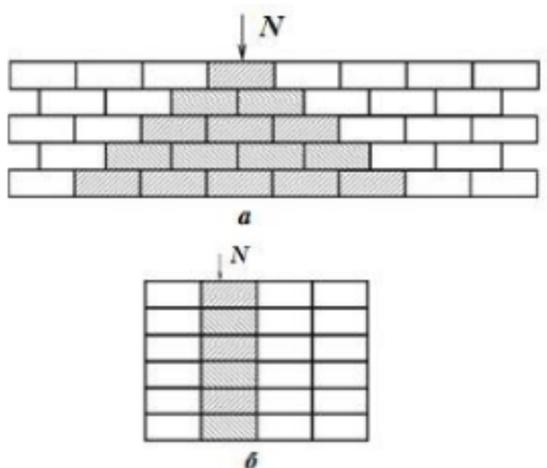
Распределение нагрузки на отдельные камни кладки:
